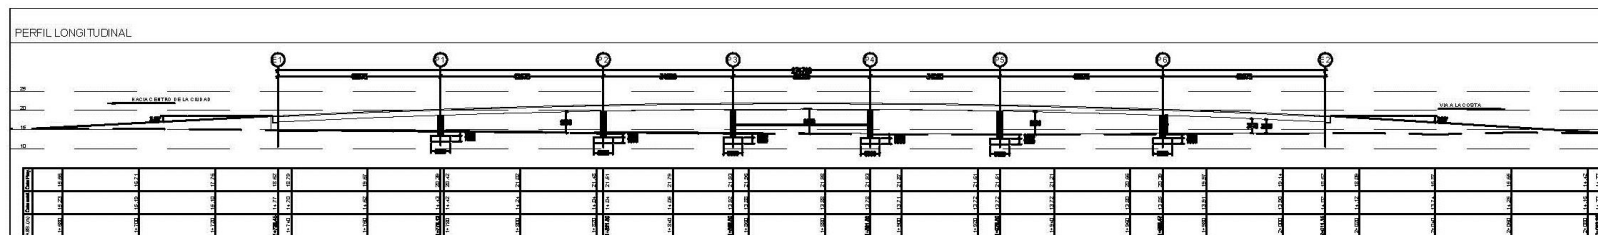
Detalle de la vista longitudinal del paso elevado alternativa
